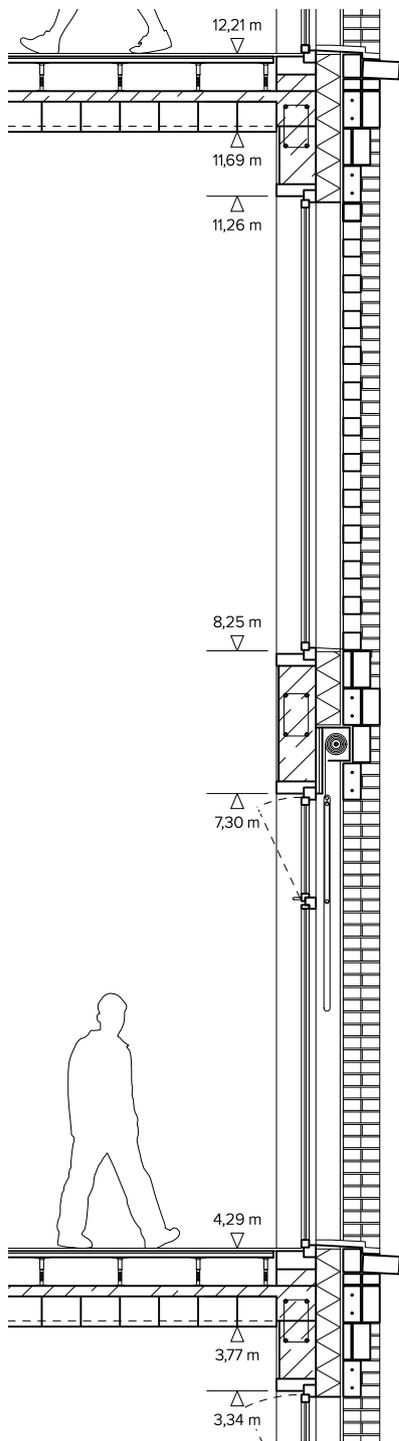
Fassadenschnitt 1. und 2. Obergeschoss 1.50 (BM)
